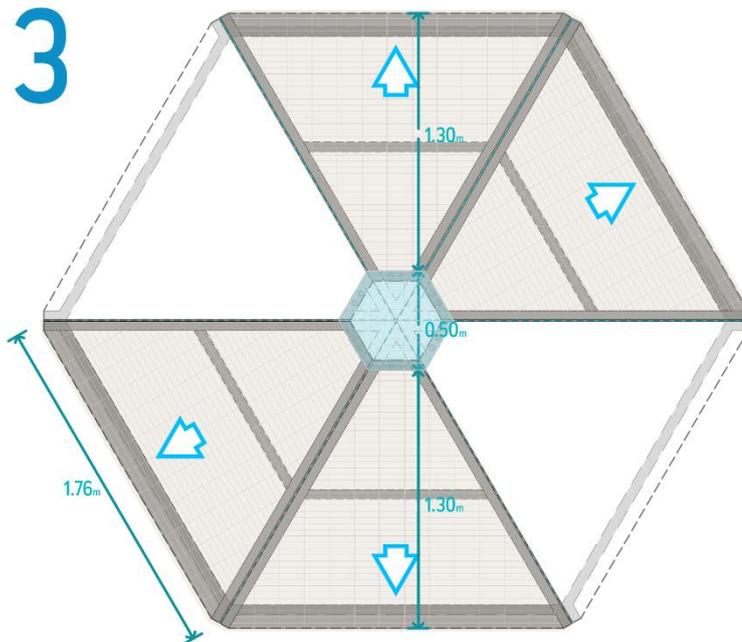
, Proceso de armado cubierta 3 paso, fuente: Autor.
